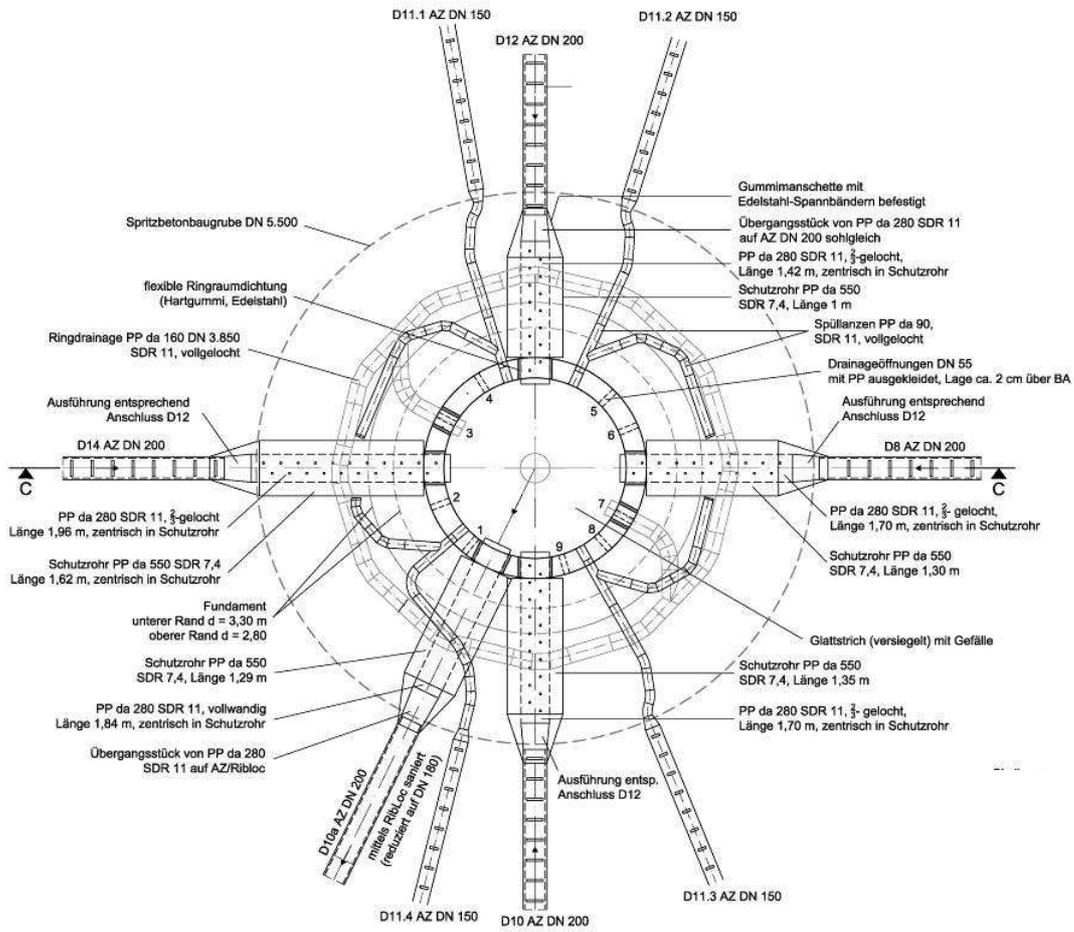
Planausschnitt des neuen Schachtunterteils mit allen angeschlossenen Leitungen
